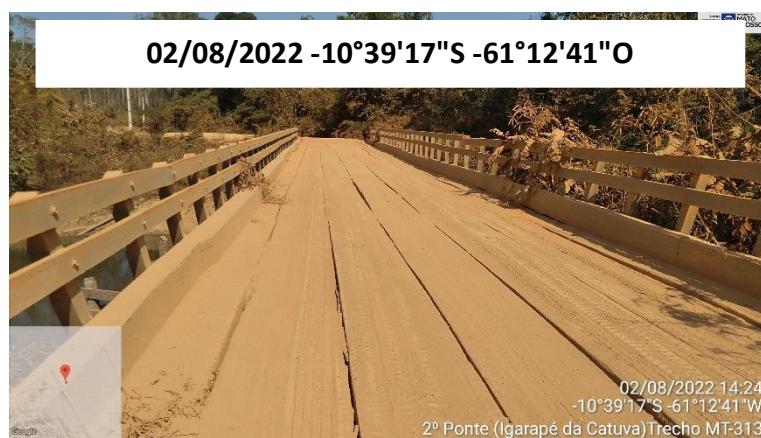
VISTA PONTE DE MADEIRA, IGARAPÉ DA CATUVA
